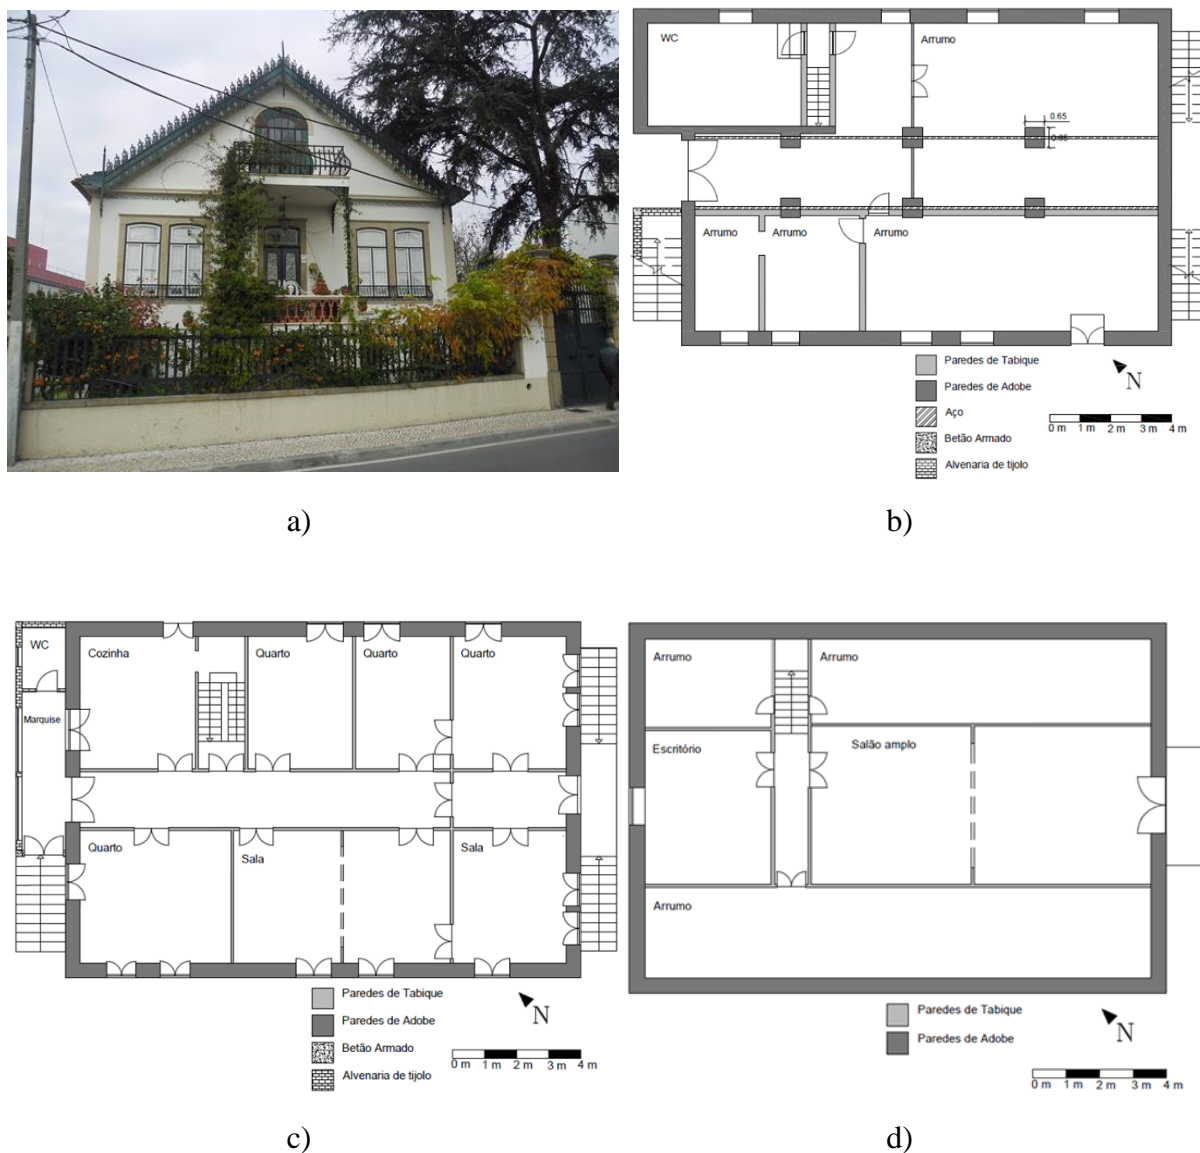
Configuração do edifício. a) Fachada principal; b) Planta do r/c; c) Planta do 1º andar; d) Planta do sótão.
